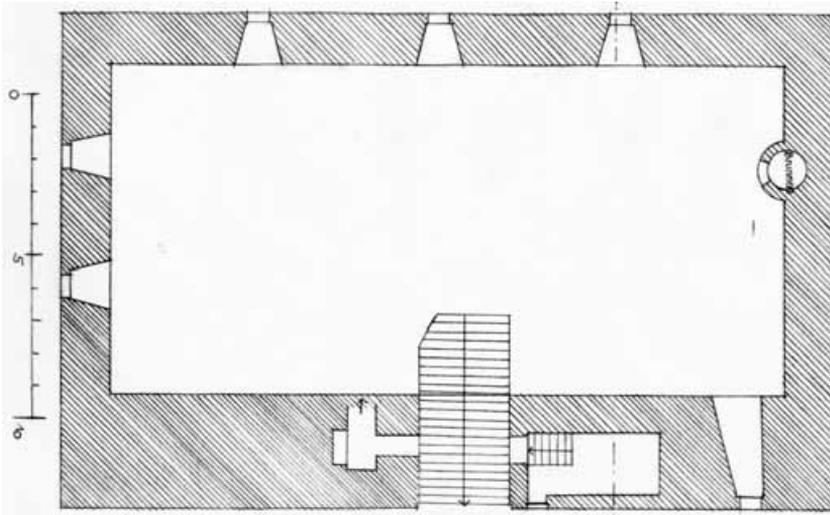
Zwiefalterhofstraße 4, Untergeschoss-Grundriss ohne Einzeichnung der geplanten Luftschutzeinrichtungen, August 1944 (Neuzeichnung 2006); oben die Mauerstraße, unten der Kellerzugang vom Hof.
